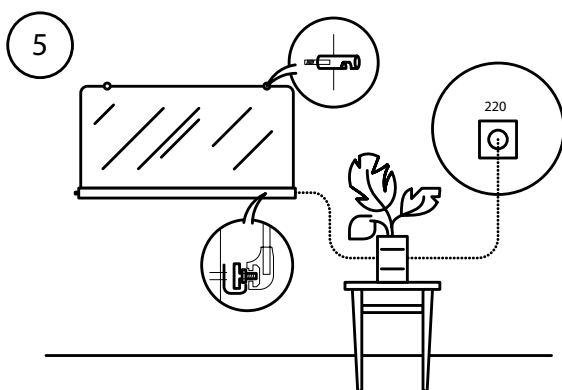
Installation d'un chauffage mural ThermoUp Wall
